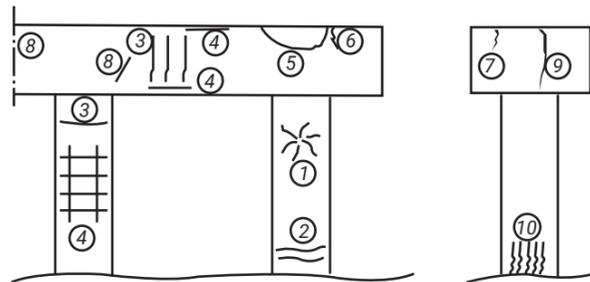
Основные виды повреждений в свайных и стоечных опорах: 1 – усадочные трещины; 2 – силовые трещины; 3 – коррозионные трещины вдоль хомутов; 4 – коррозионные трещины вдоль рабочей арматуры; 5 – криволинейные трещины в насадках под балками; 6 – силовая трещина в корне консоли насадки в поперечном направлении; 7 – силовая трещина в корне консоли насадки в продольном направлении; 8 – косые трещины от главных растягивающих напряжений; 9 – силовые трещины в торце насадки; 10 – трещины в свае в месте ее входа в грунт или в воду
